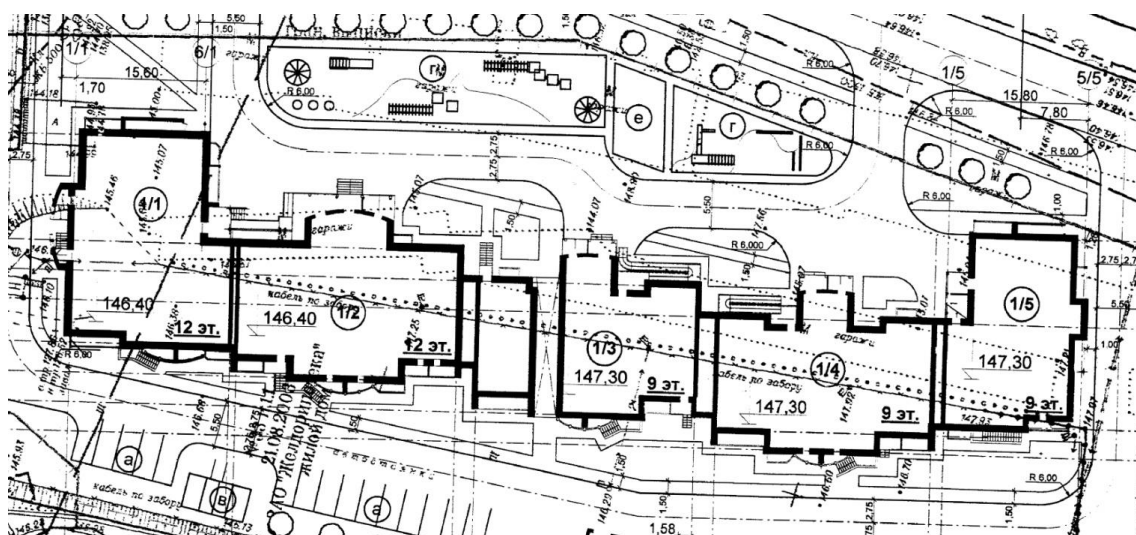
Фрагмент генерального плана жилого дома № 116/1 по ул. Кропоткина в Новосибирске.
